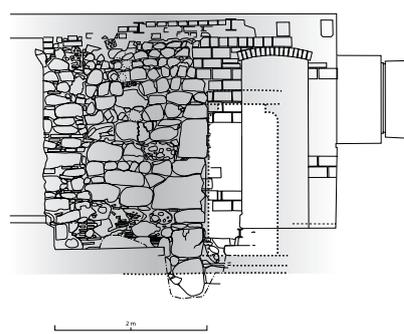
Zug, Unteraltstadt 10 (Kat. 9). Ansicht der Mauer nach Norden. M 1:100. Plan KA ZG, S. Pungitore.
